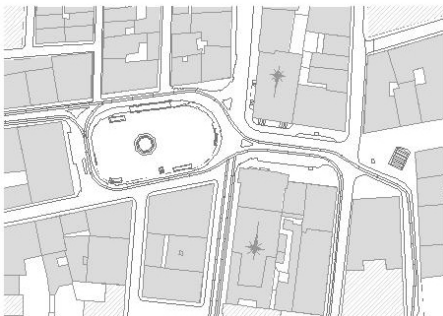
Planta da Praça Luís de Camões (anexo A02)
